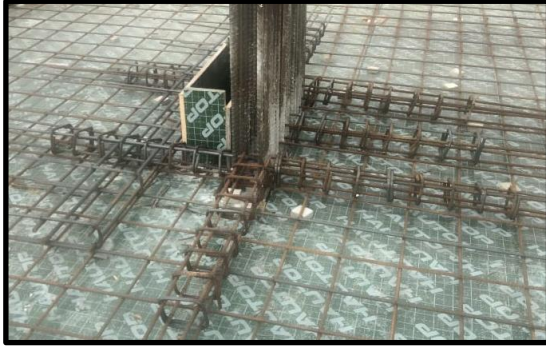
Ferrailage résistant au poinçonnement au niveau des poteaux
